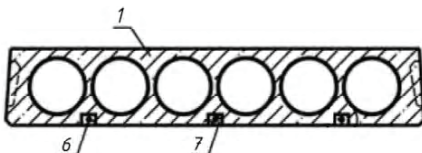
Установка дополнительных арматурных стержней в пазах на полимеррастворе: 1 – усиливаемая плита; 6 – дополнительный арматурный стержень; 7 – полимерраствор.
